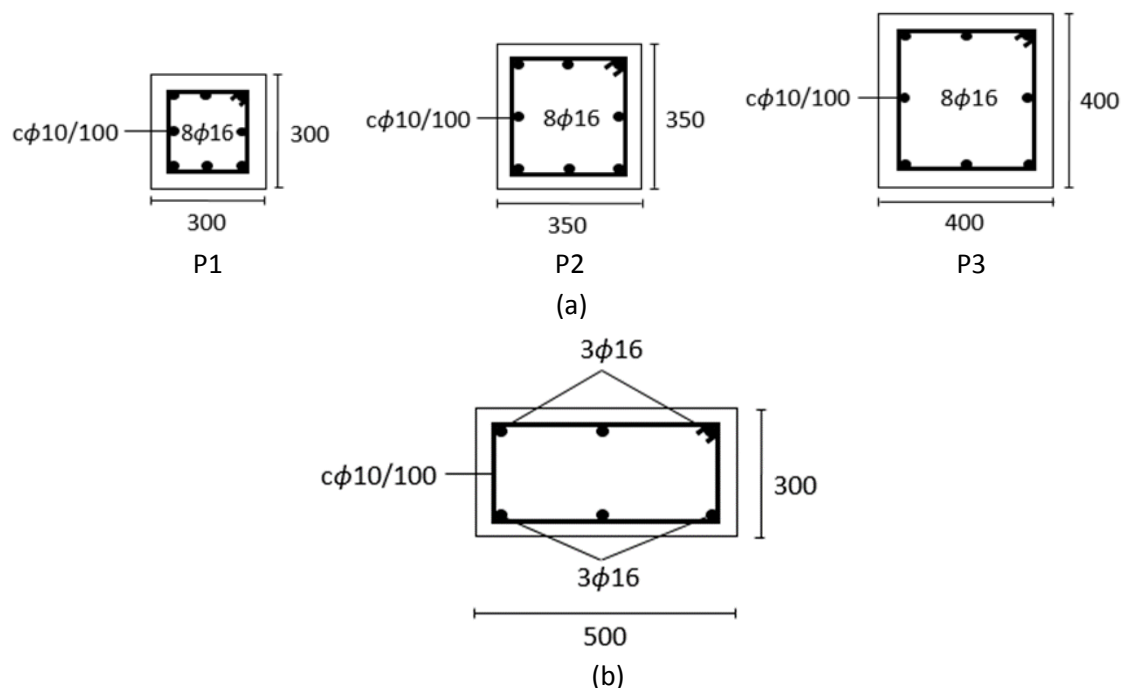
Secciones transversales del pórtico de 5 plantas. (a) Pilares. (b). Vigas.
